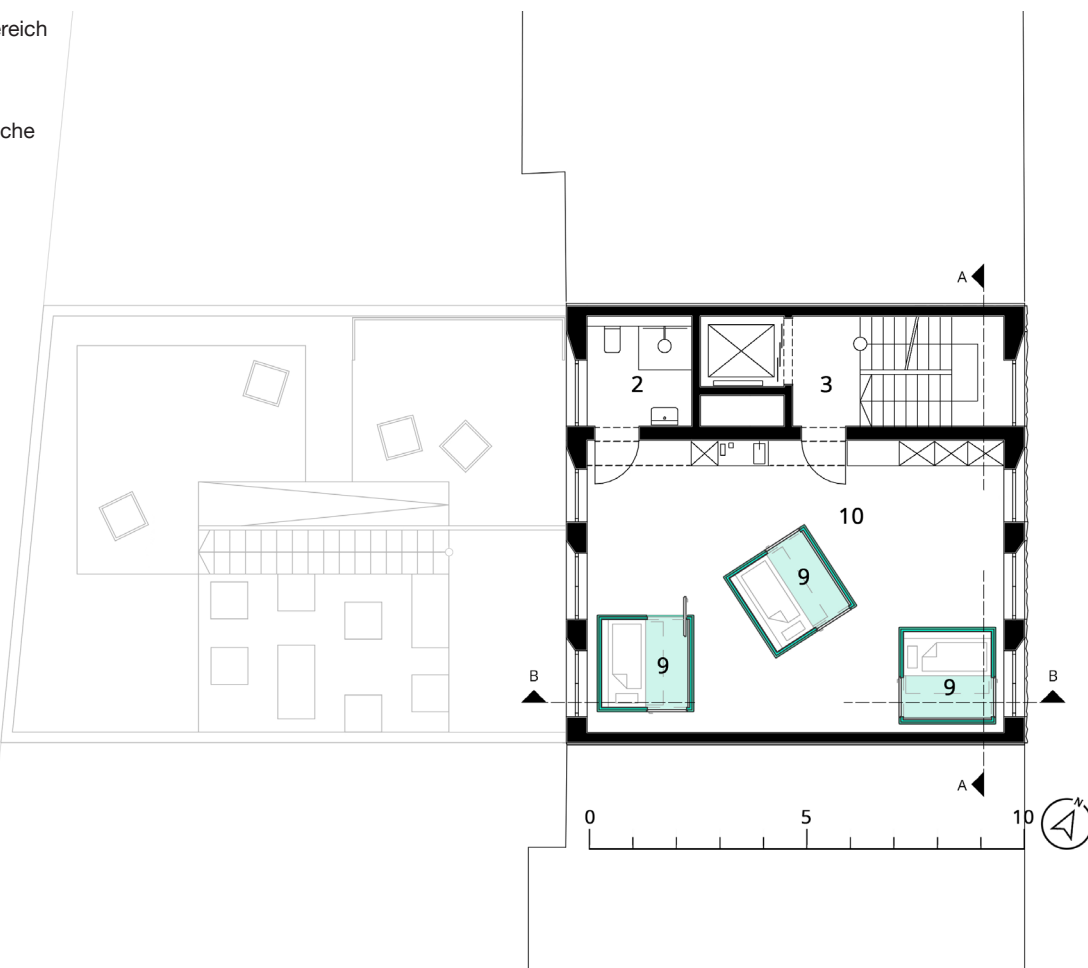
Grundriss – DC Regelgeschoss
